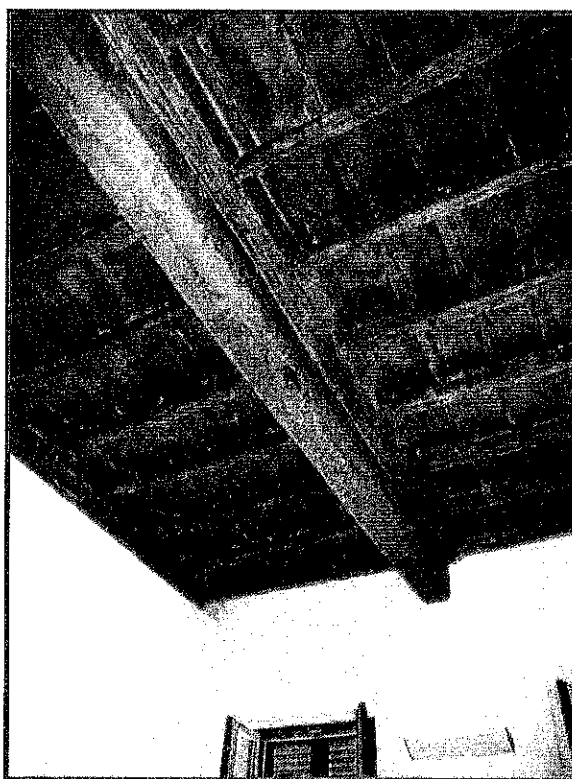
PARTICOLARE CONTROSOFFITTO IN LEGNO
